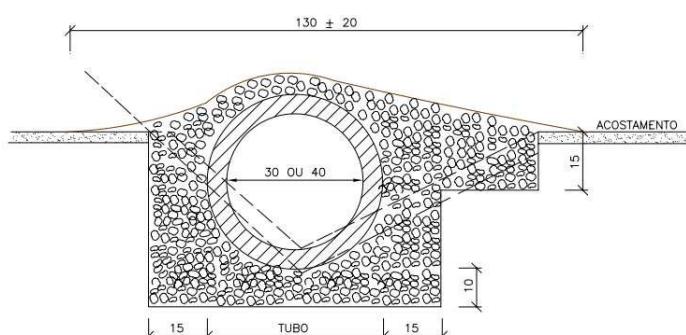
Seção transversal do dispositivo de transporte de sarjeta, do tipo TSS01 (medidas em cm)
